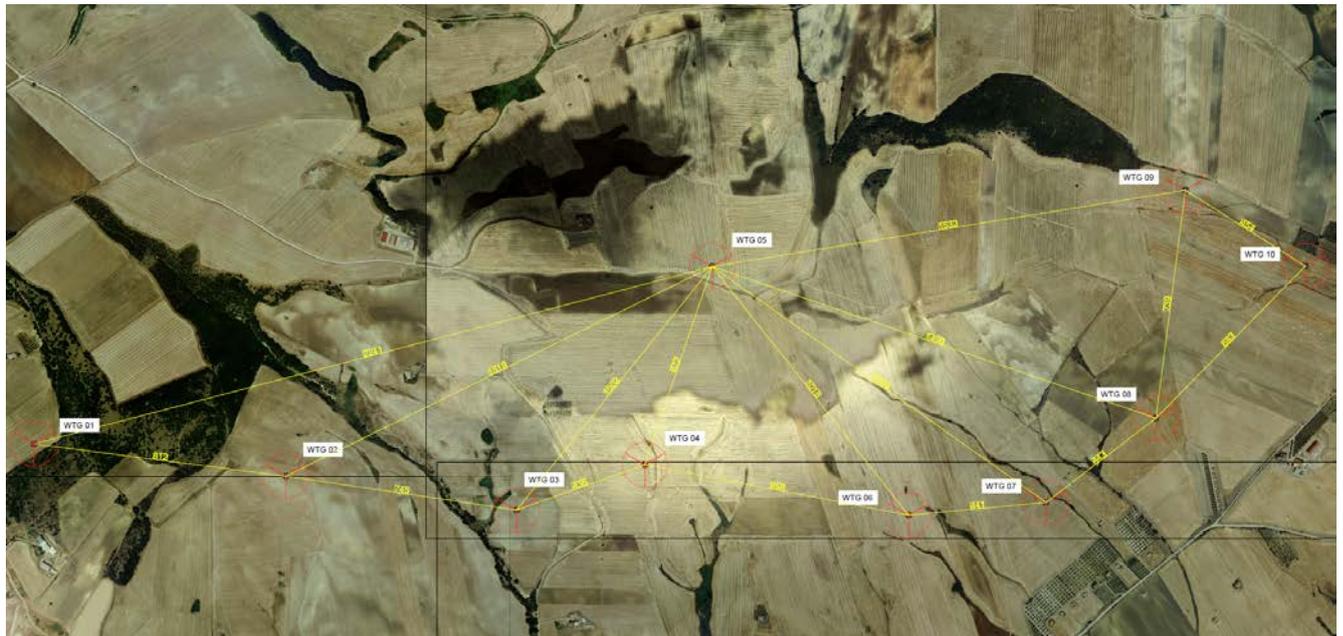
Estratto tavola A.16.b.1.2 Planimetria con distanze aerogeneratori
